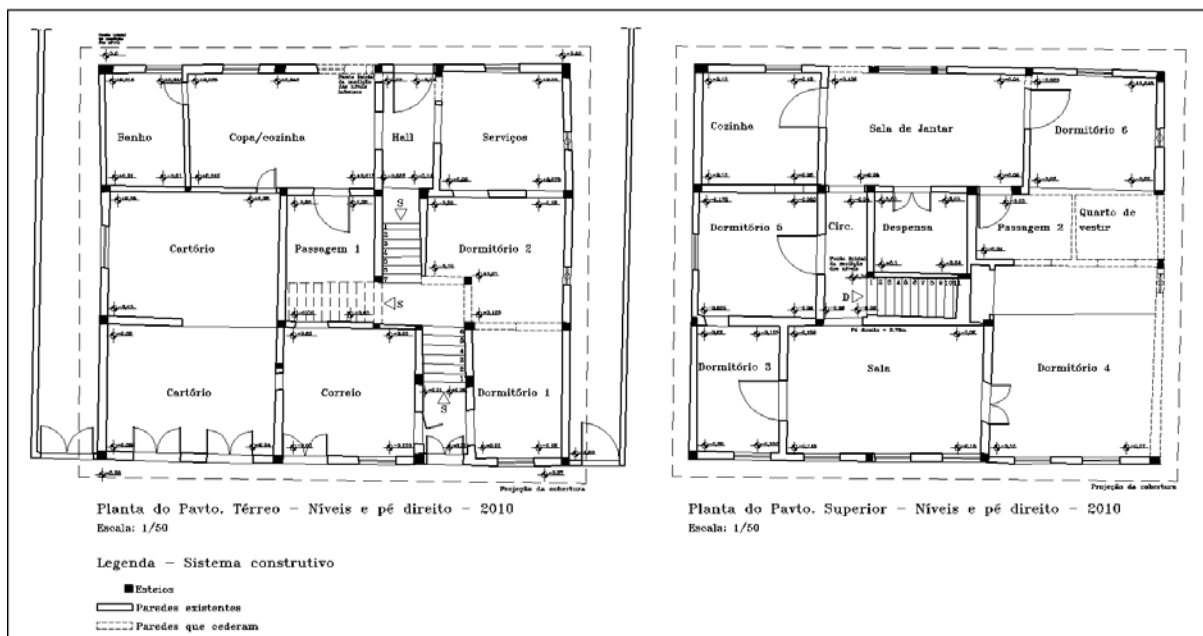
Levantamento da planta e do nivelamento do Sobrado do Cartório, realizado em 2010/11 (Fonte: Peixoto, 2011)
